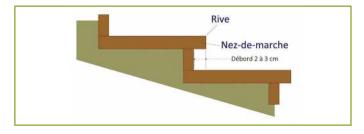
Coupe de principe d'une marche d'escalier (Dessin de Cédric Houel)
